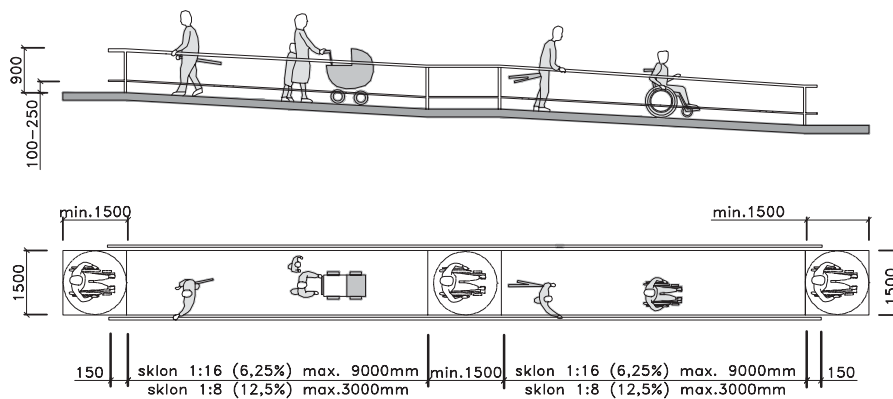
Vybavení rampy soklem a vodicí tyčí
